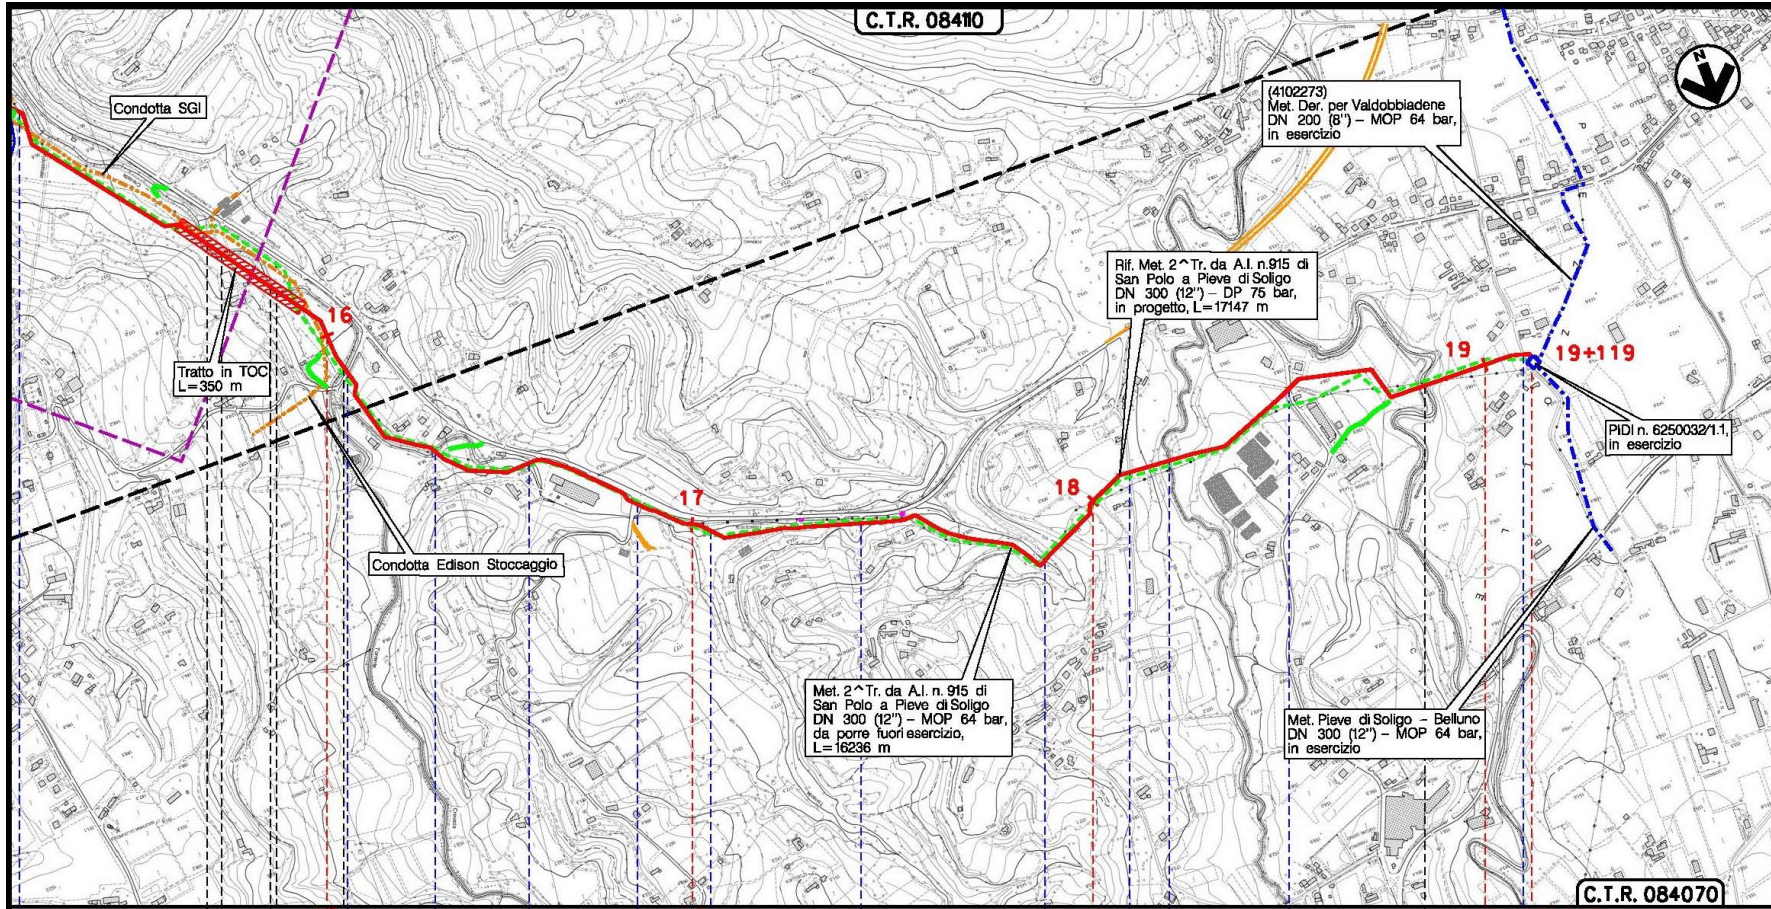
Stralcio planimetria CTR con localizzazione dell'area di intervento 2° tratto – parte 5
